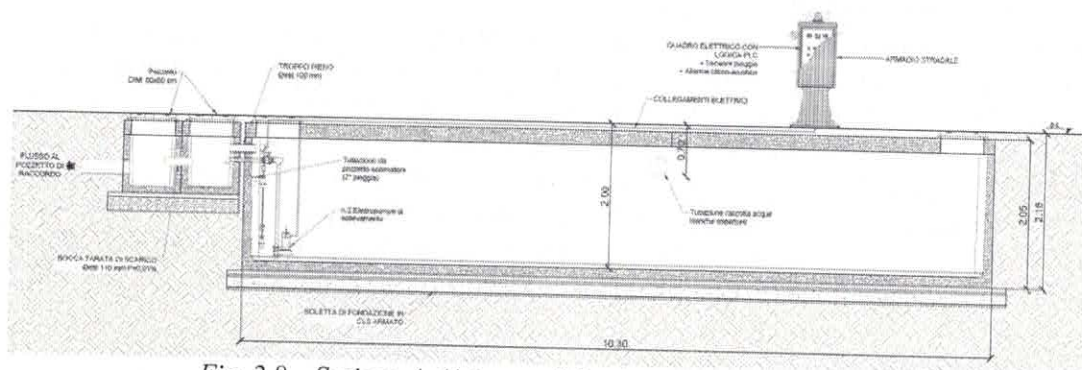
Sezione A-A' (vasca di laminazione, stralcio Tav. 8)
